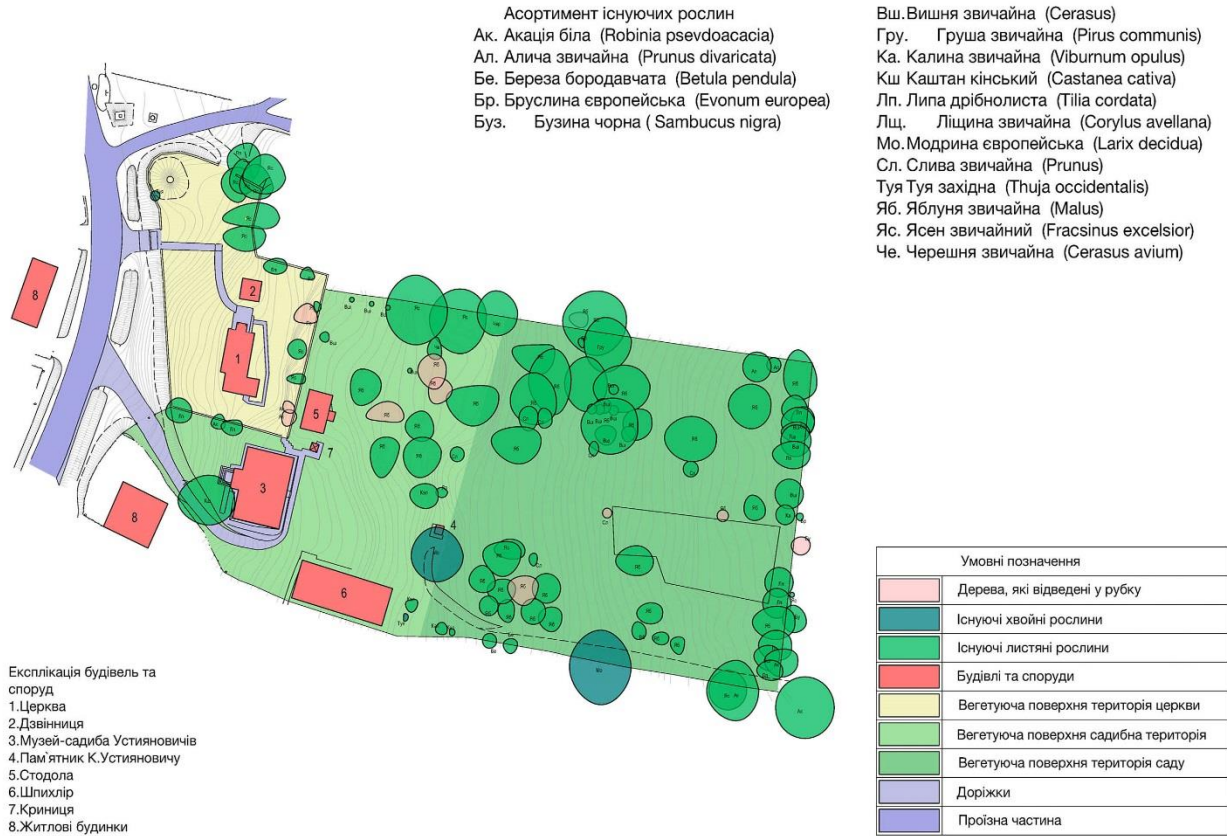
Опорний план насаджень на музеї-садибі Устяновичів у селі Вовків.
